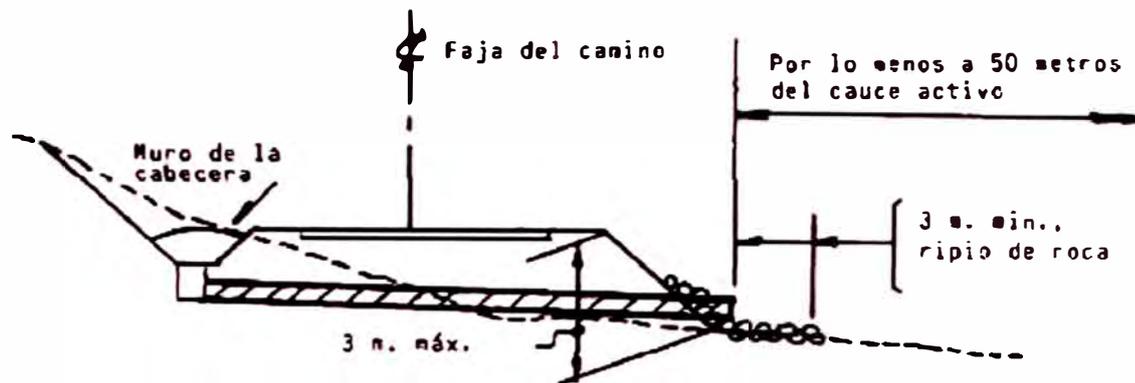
Alcantarilla de paso y protección de piedra
